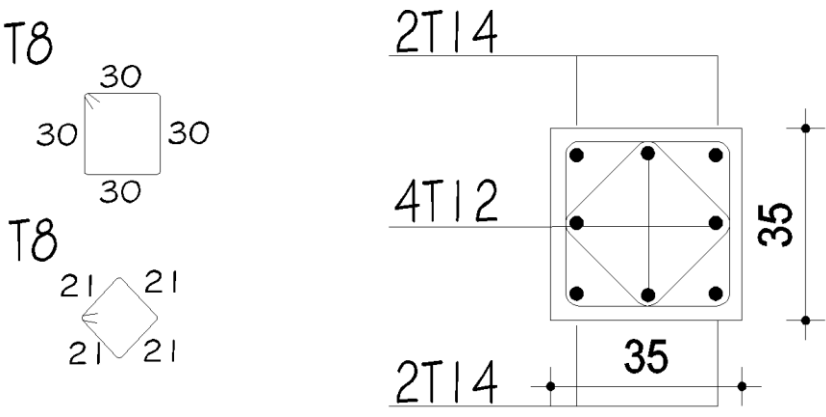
Ferrailage poteau (35×35)(\*).
